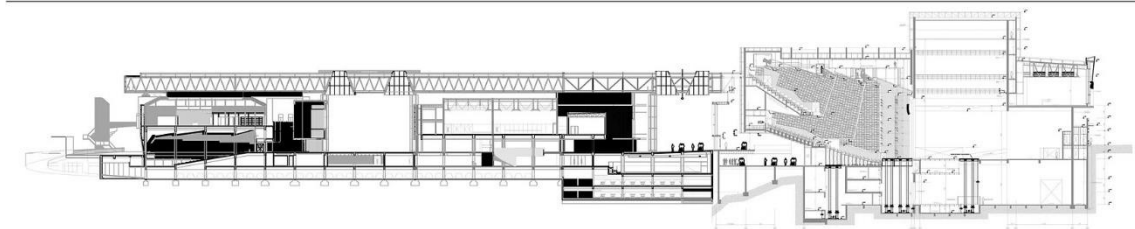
Corte arquitectónico del edificio, etapa 2.
